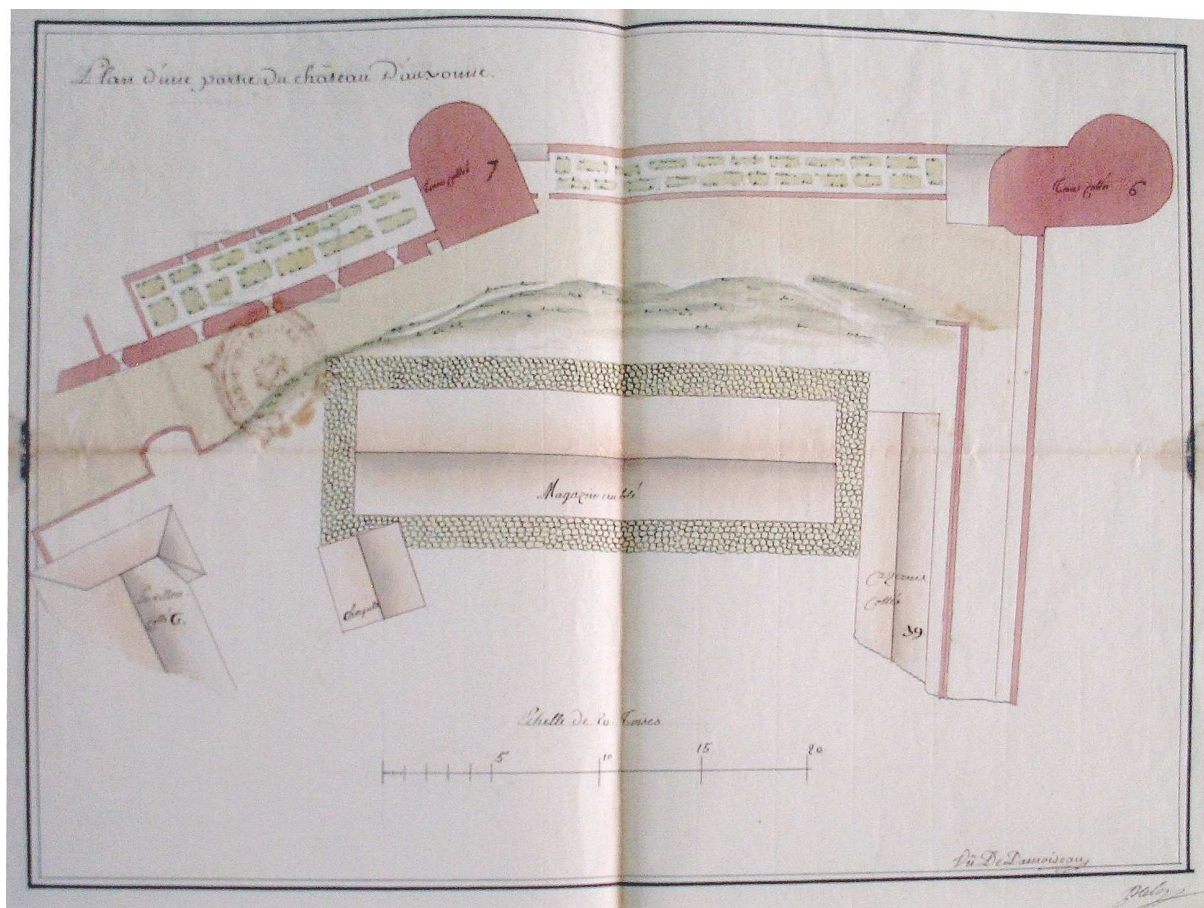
Plan d'une partie du château d'Auxonne en 1776 (SHAT, art. 8 sec. 1 , Auxonne car. 1)
